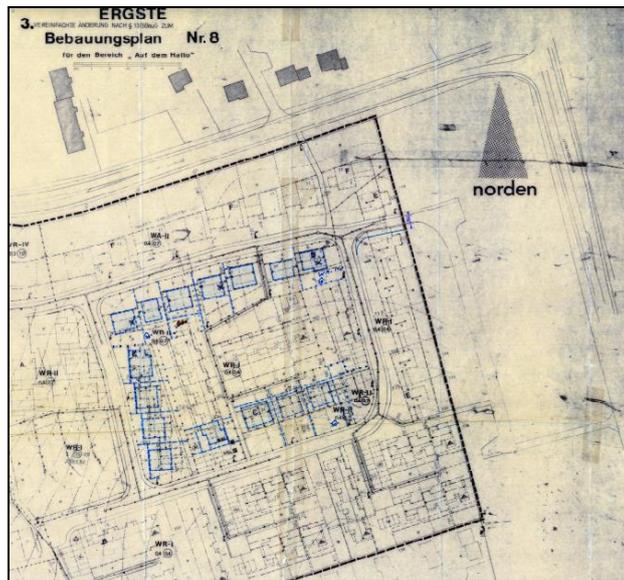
Ausschnitt – Bebauungsplan Nr. 8 „Auf dem Hallo“, 3. Änderung (Quelle: Stadt Schwerte)
